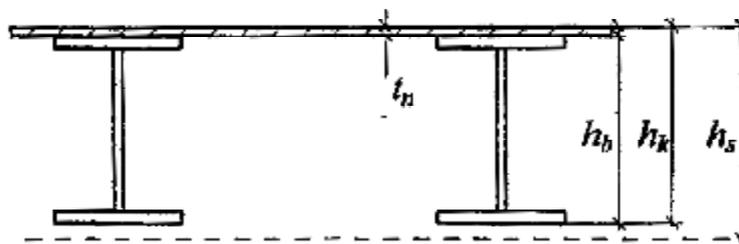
К определению конструктивной высоты балки ( $h_s$ -строительная высота перекрытия,  $t_n$  -толщина настила).
